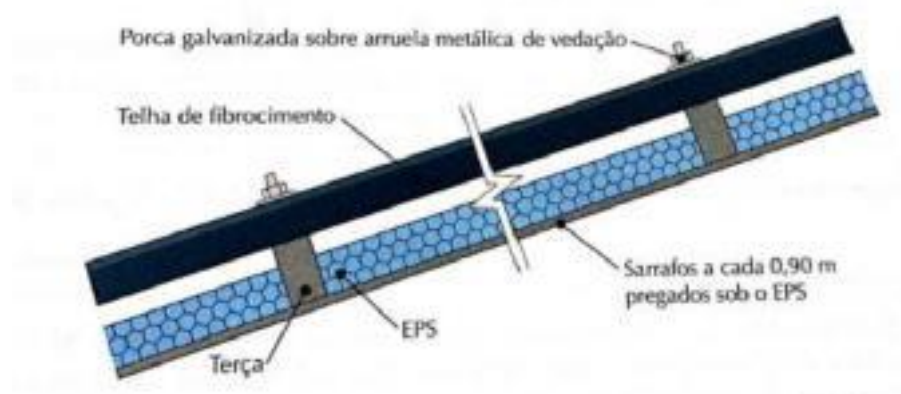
Isolamento térmico de telhados de fibrocimento e estrutura metálica.
